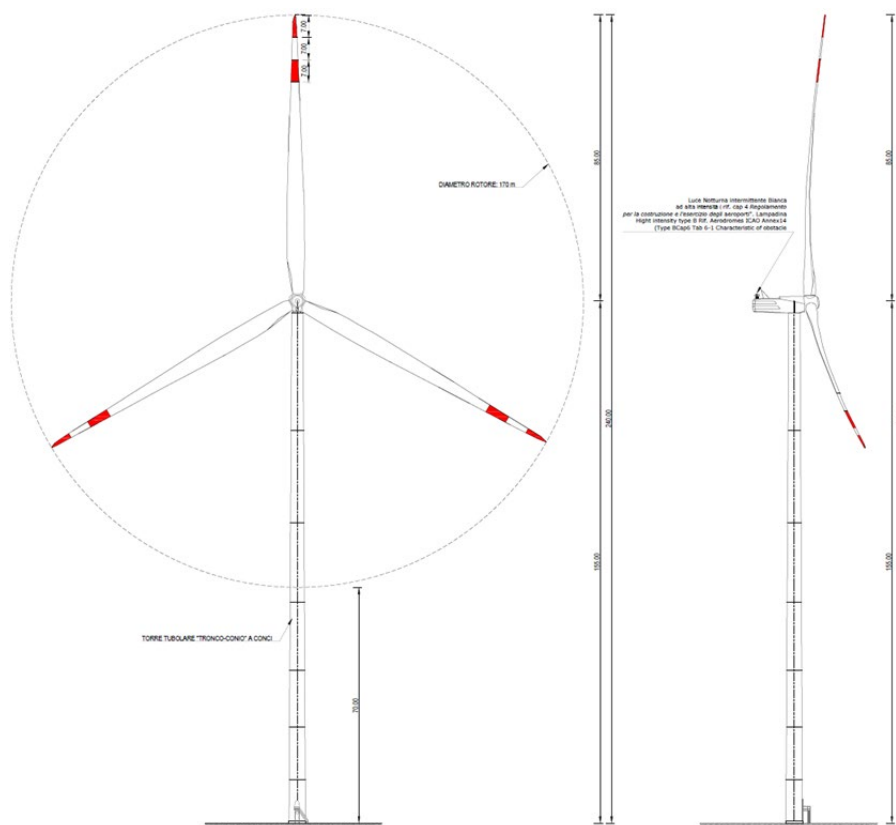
Vista prospettica e laterale dell'aerogeneratore SIEMENS GAMESA SG 6.6- 170 da max 6,6 MW
